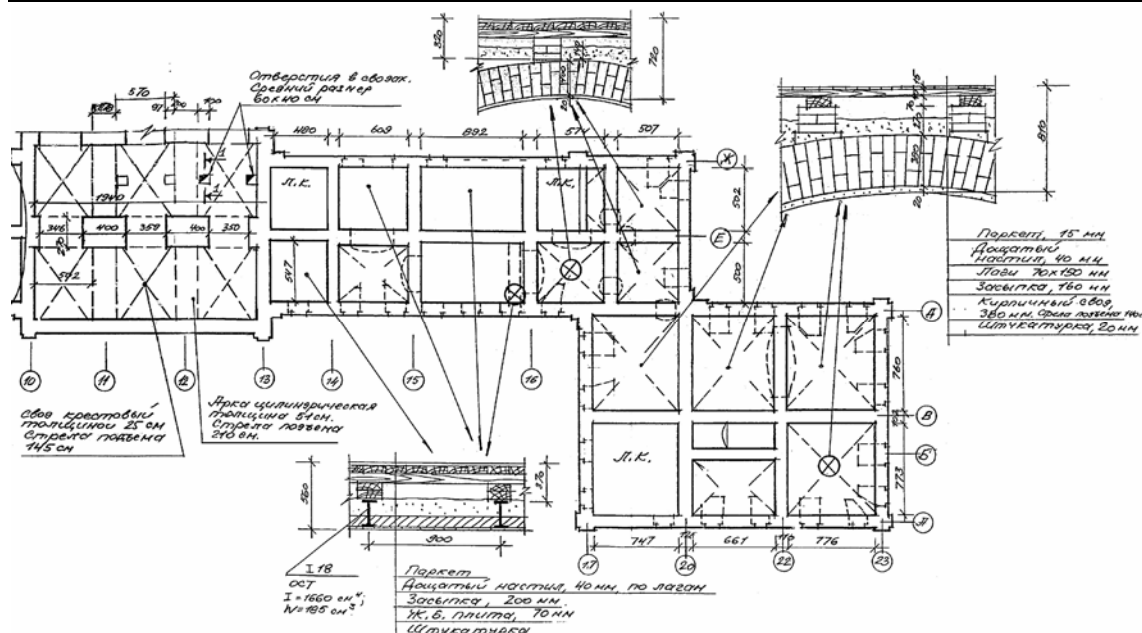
Схема перекрытия над подвалом (фрагмент)
